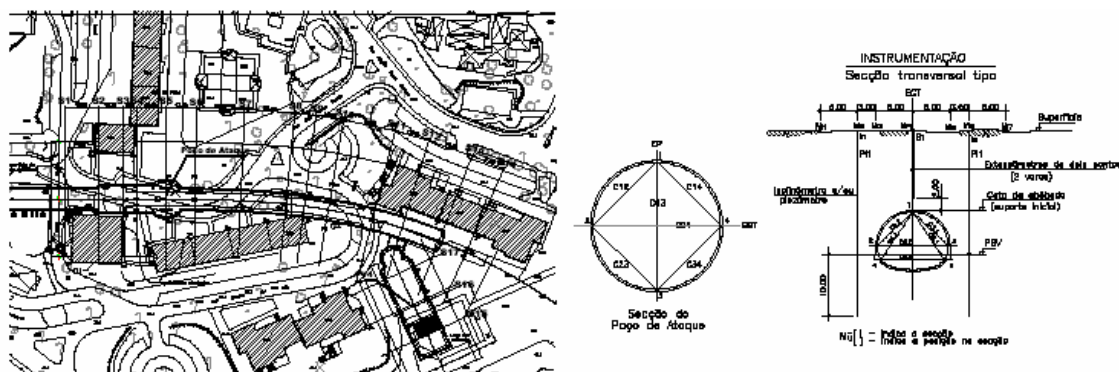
Término de Odivelas. Plano de Observação. Planta e secções tipo. (Melâneo, et al. 2004a).
